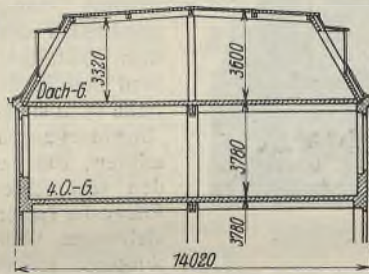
Querschnitt des betroffenen Gebäudeteiles.
